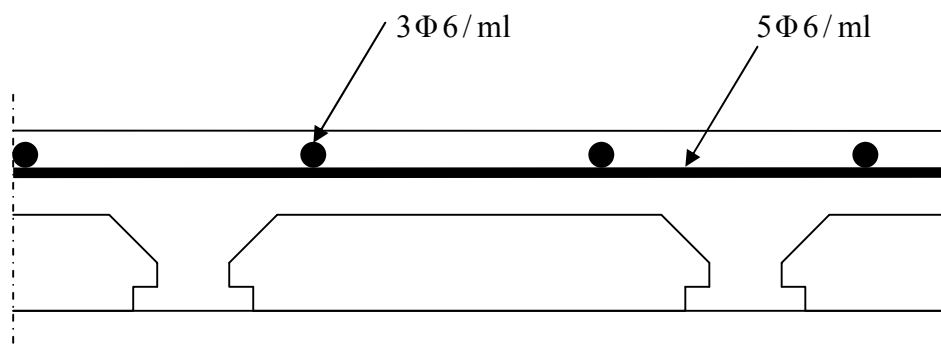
Schéma de ferrailage de la dalle de compression.
